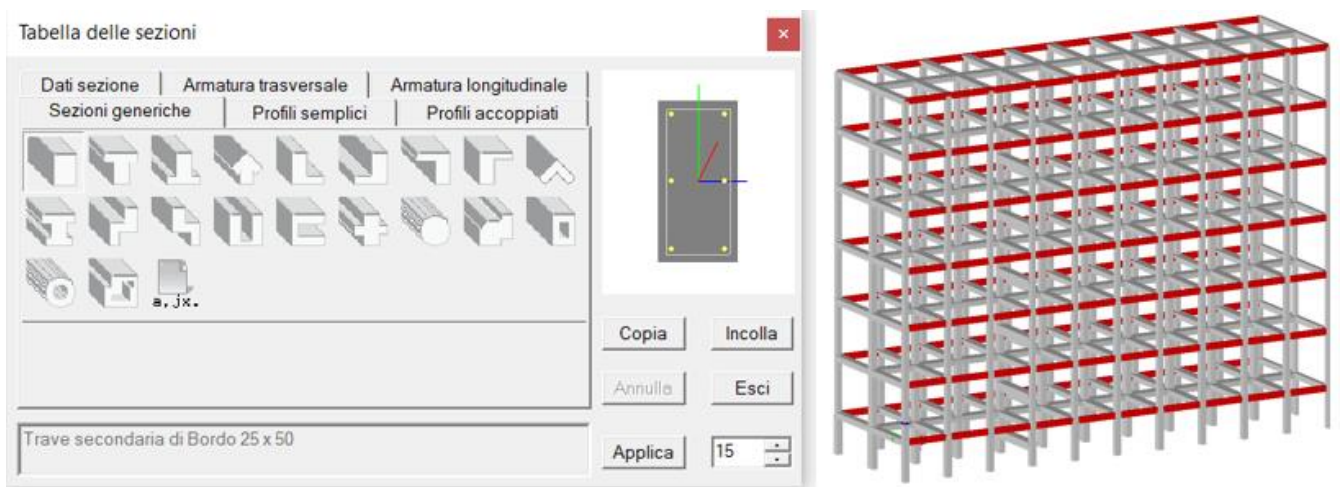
Modello US B1 - PROSAP, Archivio Sezioni, Proprietà n° 15 Trave Secondaria di bordo, con inquadramento.
